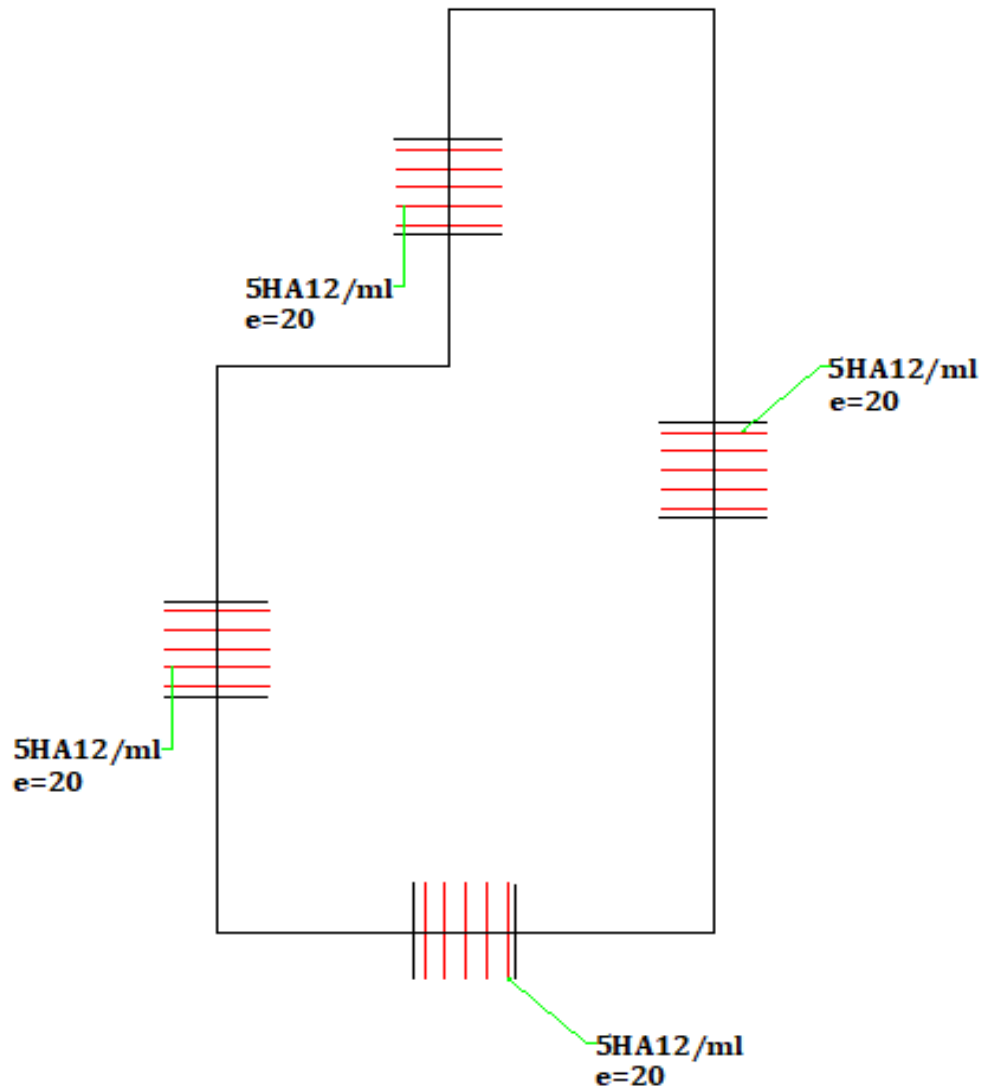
Ferrailage de plancher dalle N+0,00 et RDC.
